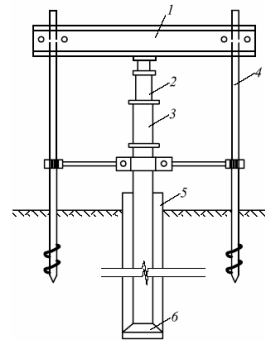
Схема установки для испытания грунтов в скважине пробной нагрузкой:
